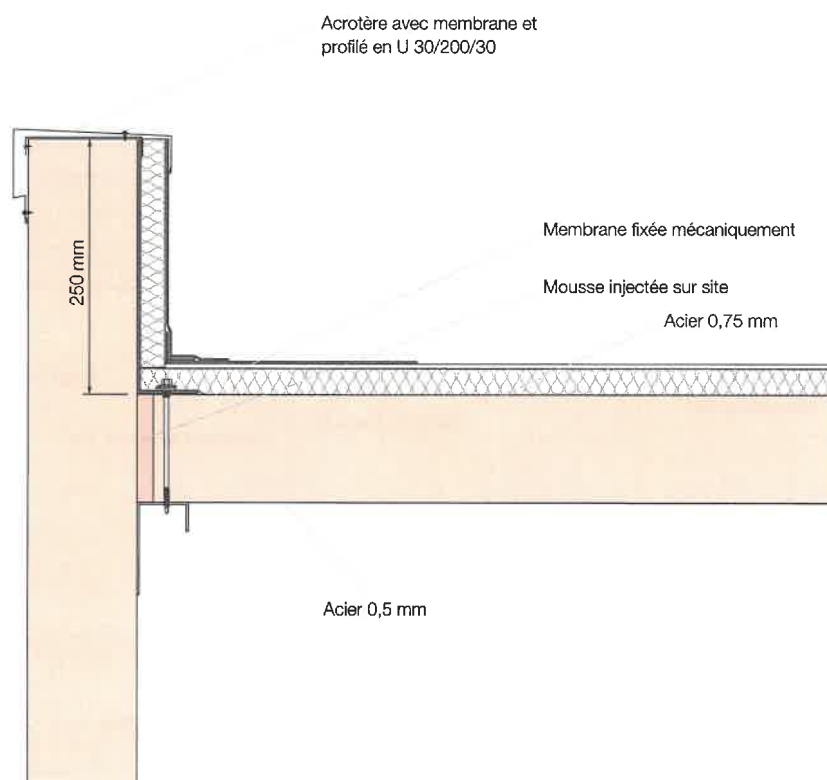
Détail d'utilisation pour toiture plane avec complément d'isolation et membrane PVC fixée mécaniquement
